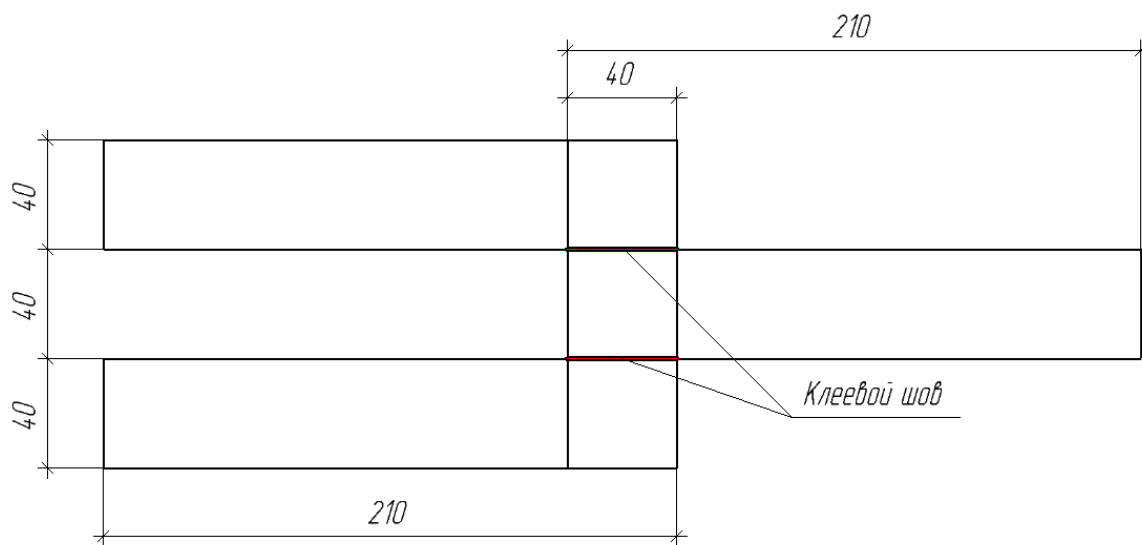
Схема образца для испытаний на двухплоскостной срез
